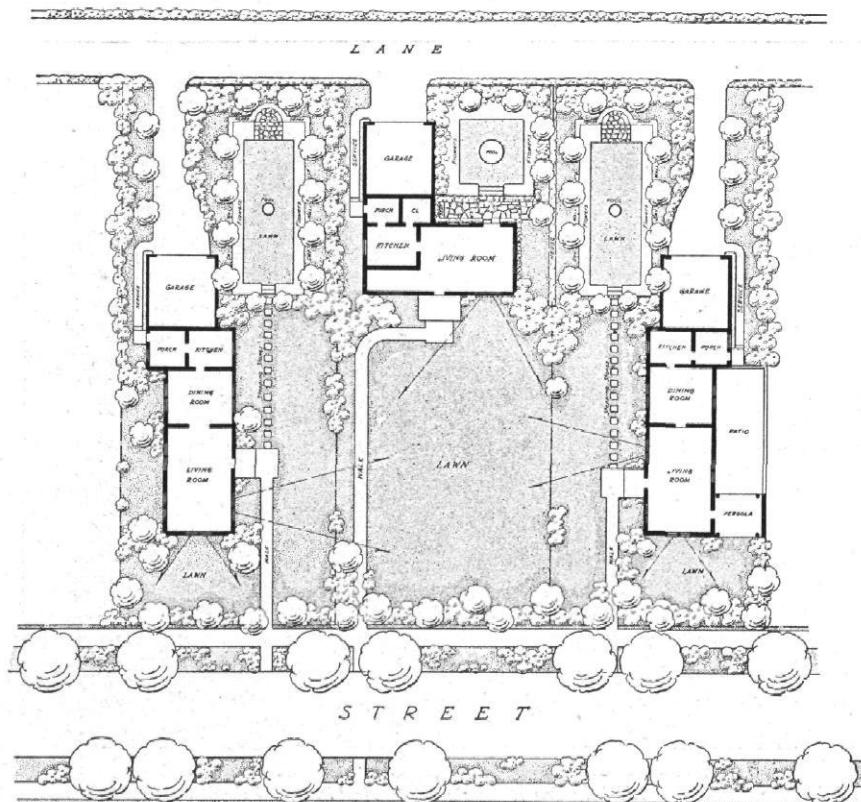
/ Lageplan einer Wohnbaugruppe für Palos Verdes / Gartenarchitekten: Brüder Olmsted
